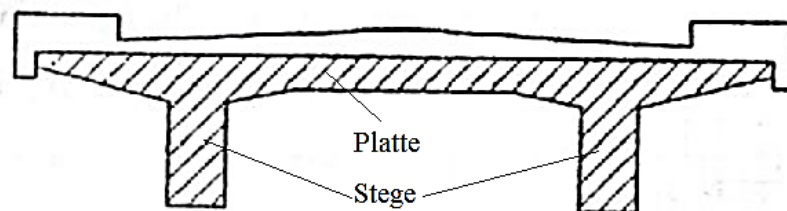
Plattenbalken mit zwei Stegen (Ortbetonkonstruktion)<sup>13</sup>
